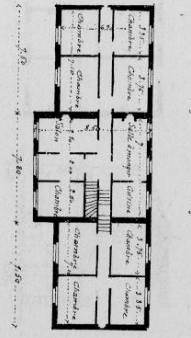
Plan du Rez-de-Chaussée à 0^m 0025 p. m.
